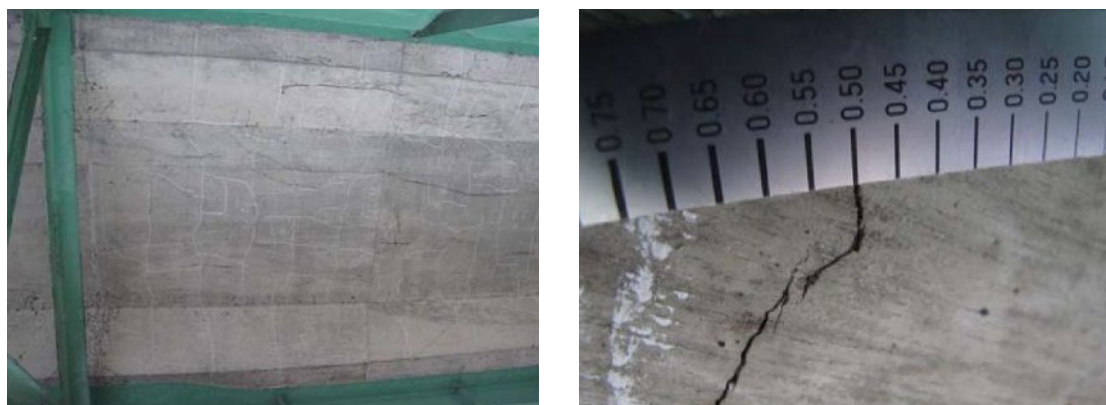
床版下面のひび割れ事例
